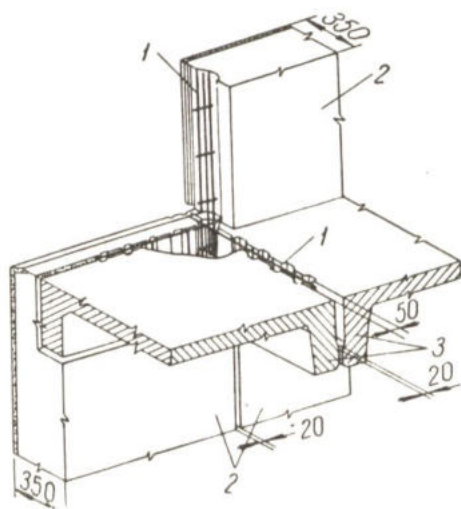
Сопряжение панелей продольной наружной стены с панелями перекрытия:
